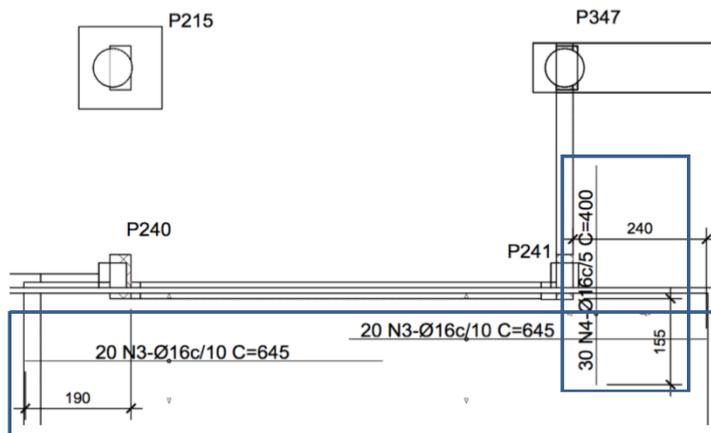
Croqui de ilustração de projeto de reforço de laje de concreto armado com adição de compósito de fibra de carbono.
